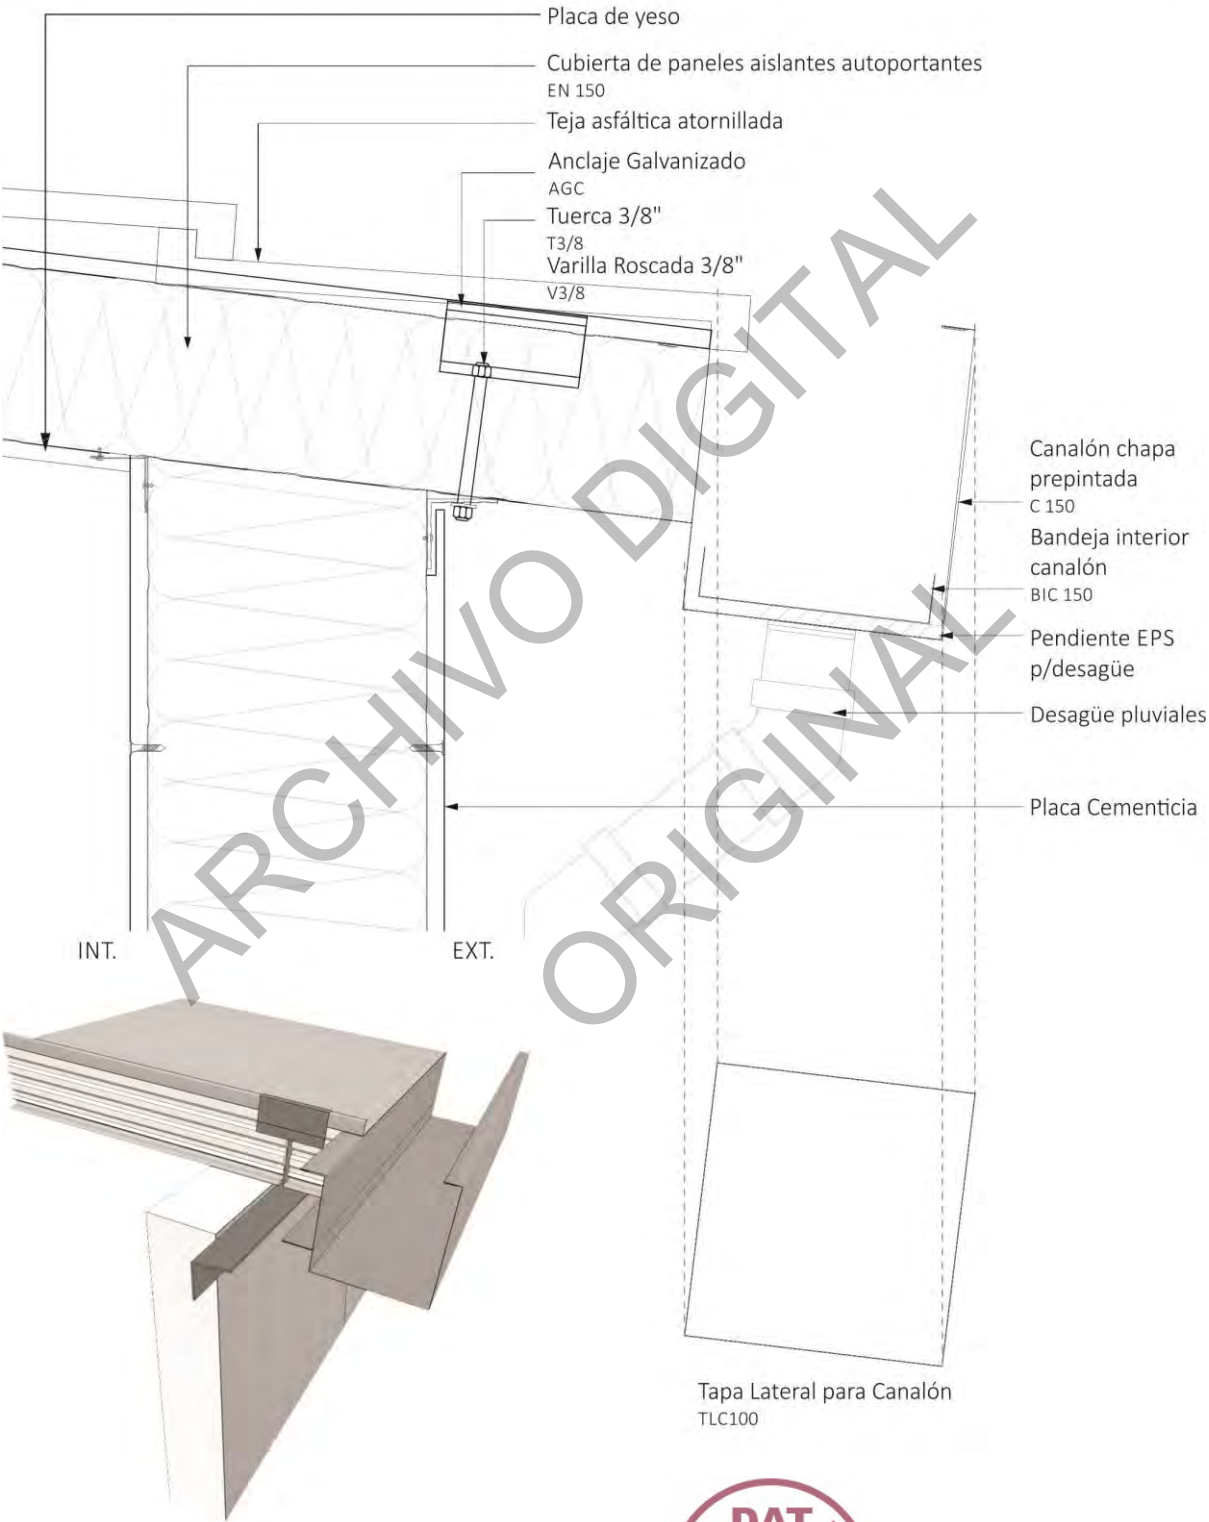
Unión paneles de cubierta con panel vertical SPM
